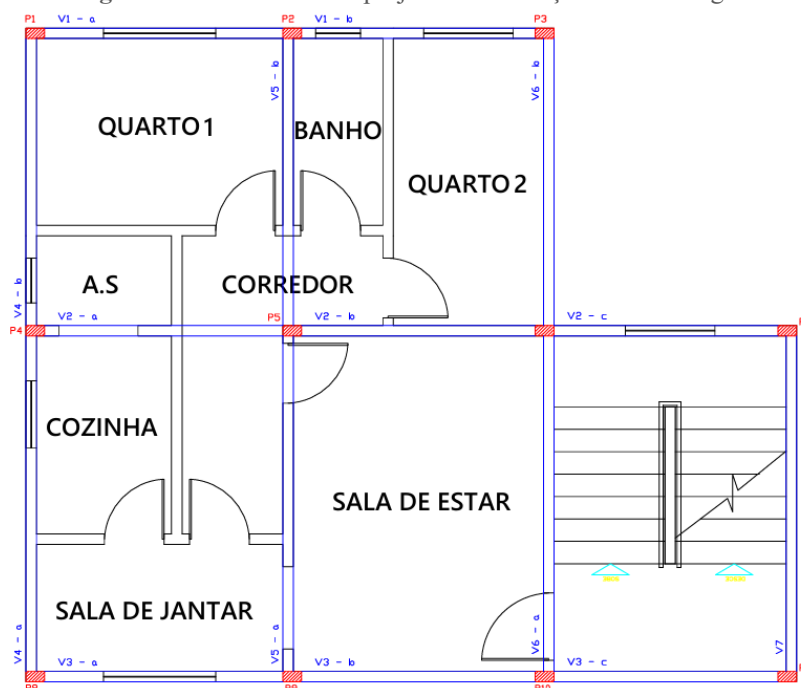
Planta Baixa do projeto com o lançamento dos pilares
